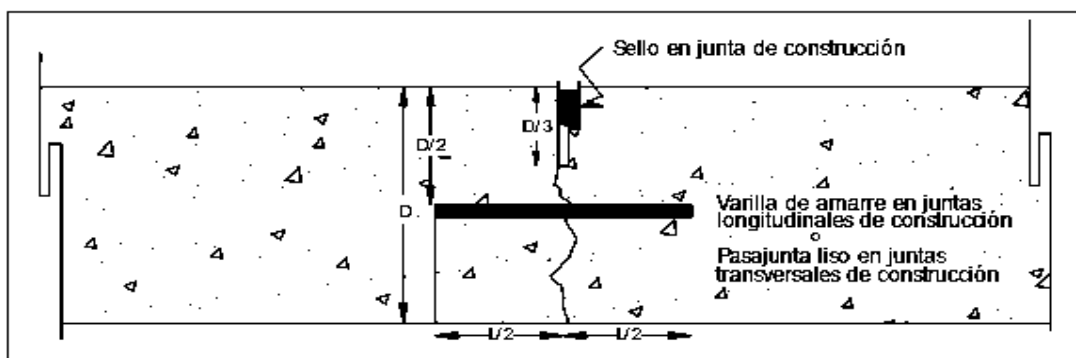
Sellado para juntas del pavimento de concreto hidráulico.
